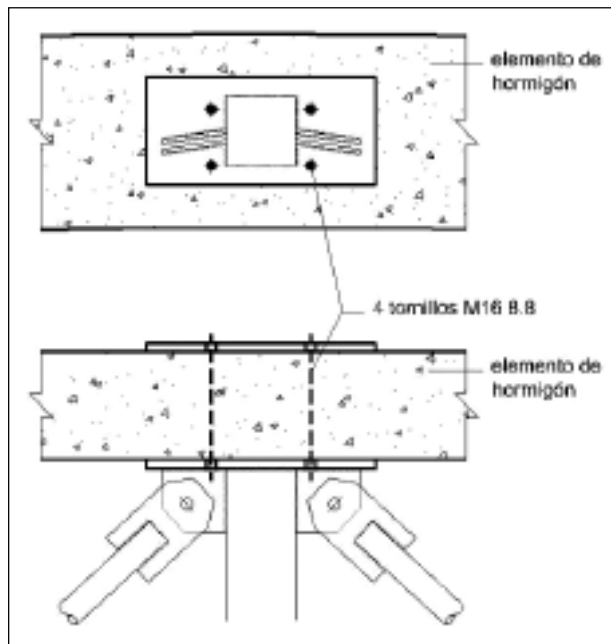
Unión hormigón-acero mediante tornillos de alta resistencia. Planta y alzado.
